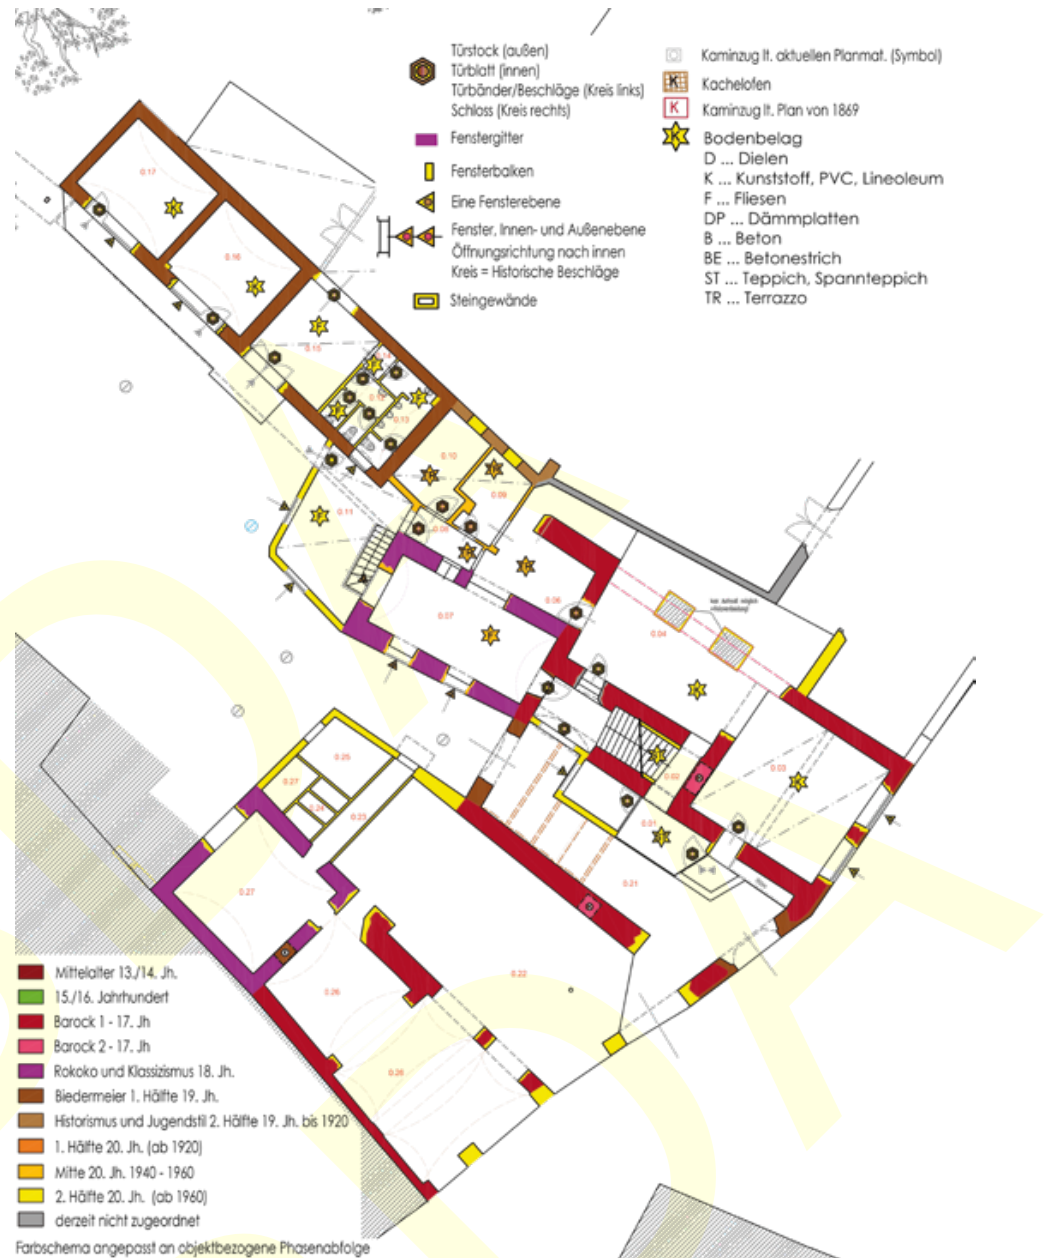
Feldkirchen, Hotel Germand. Baualterplan des Erdgeschoßes.
